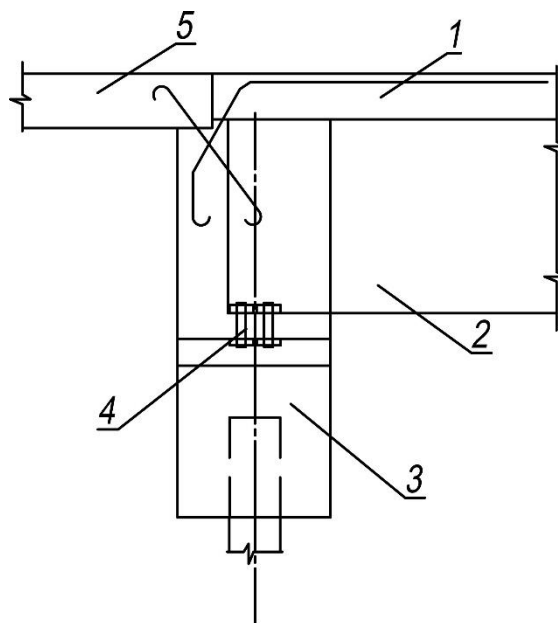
Конструкция интегрального устоя: 1 – железобетонная плита; 2 – стальная балка; 3 – оголовки свай; 4 – регулировочные болты; 5 – переходная плита
